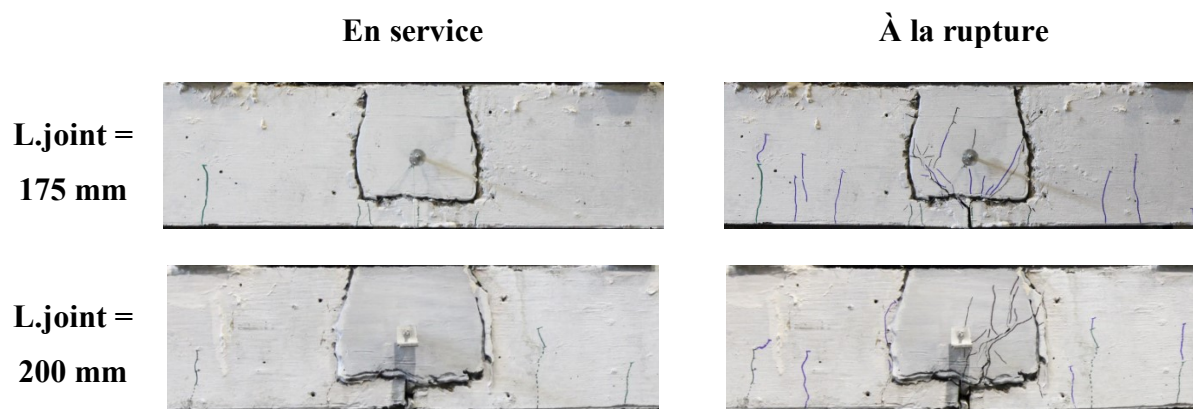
Schéma de fissure en service et à la rupture pour les dalles en BFHP avec joint de connexion longitudinal
